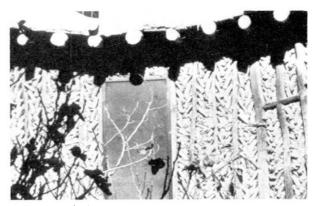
Affaissement d'un toit plat (Damas, Syrie).
